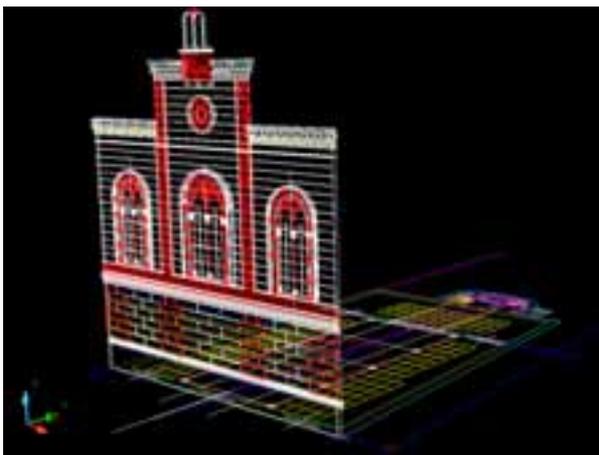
Auf der Grundlage des Grundrisses wird zunächst die Hauptfassade in AutoCAD konstruiert
